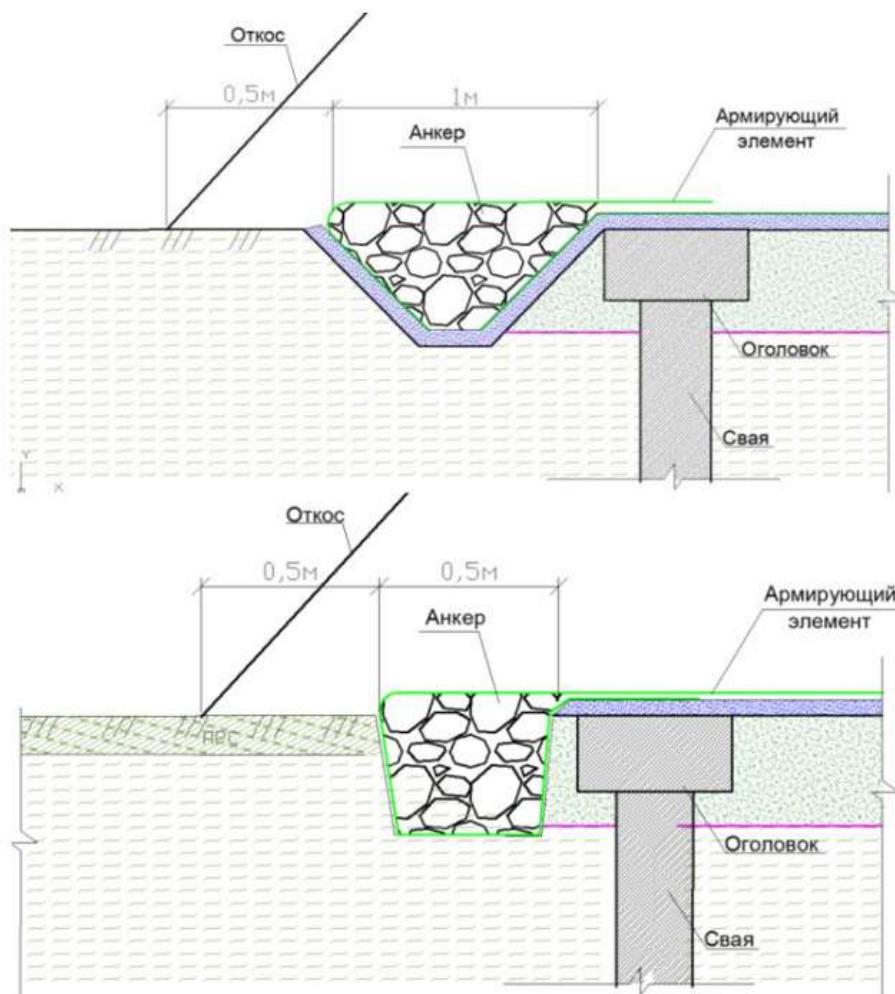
Схемы конструктивных решений по анкеровке армирующего элемента
